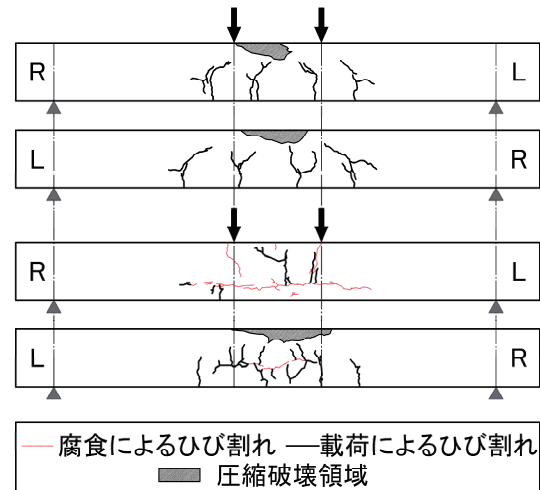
ひび割れ性状 (上 : S, 下 : A1)
